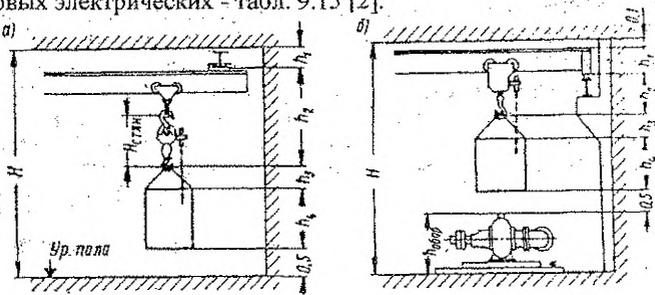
Схемы размещения грузоподъемных устройств внутри сооружений: а – подвесная кран-балка; б – мостовой кран.
